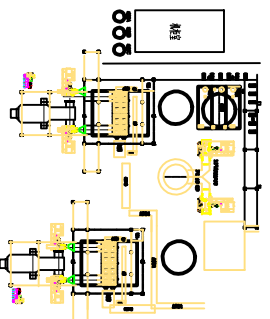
(5) 无水氯化钙造粒干燥装置区平面布置图
